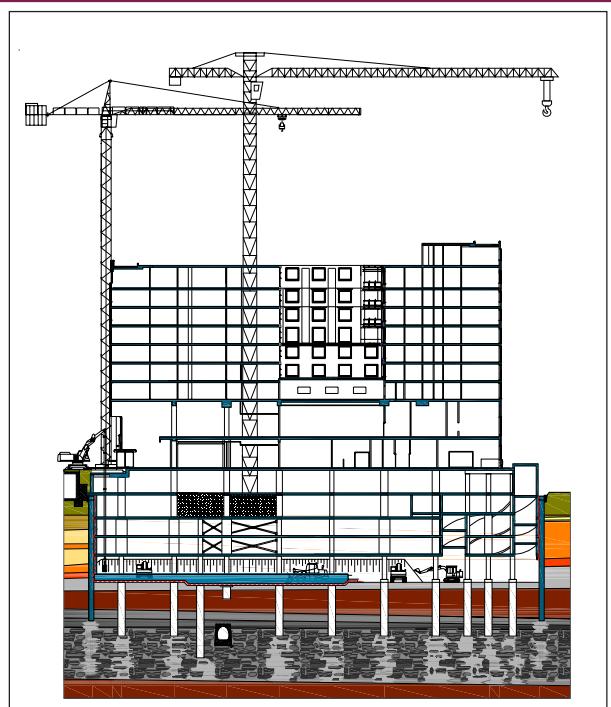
Экскавация грунта под защитой перекрытия над четвертым подземным этажом. Подготовка грунтового основания к бетонированию захватки перекрытия над пятым подземным этажом.
